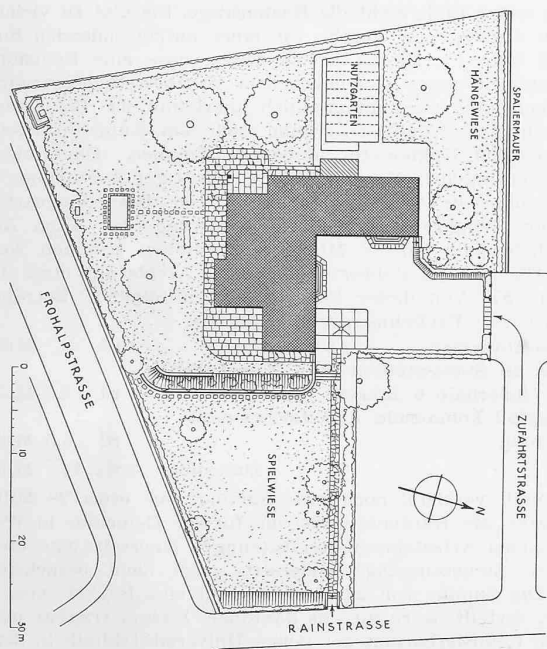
Lageplan 1:800, gleich orientiert wie Abb. 5 und 9, daher gegenüber den Grundrissen um 90° verdreht!
